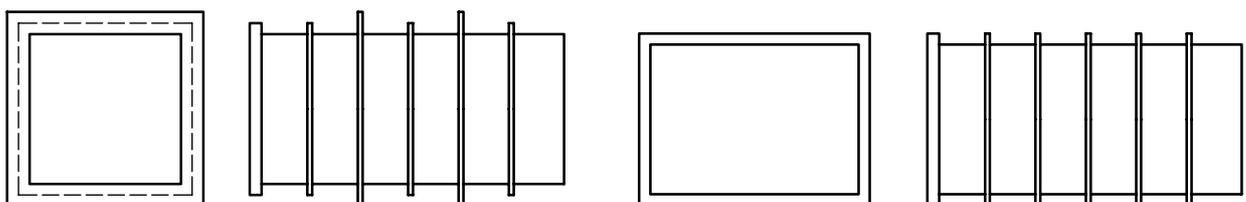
Élément de réhausse de section carrée et rectangulaire
